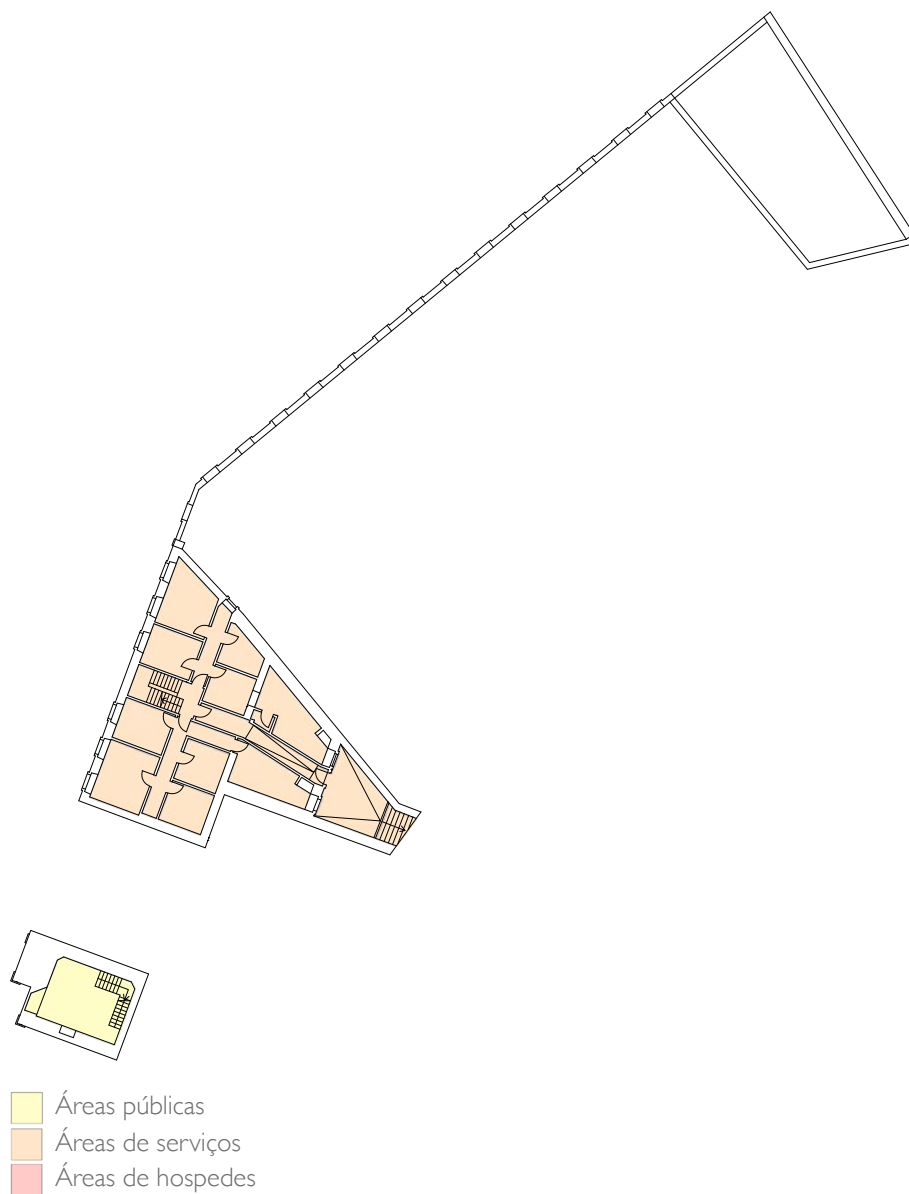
Planta original do piso - 2, à escala 1:500, orientada a Norte
